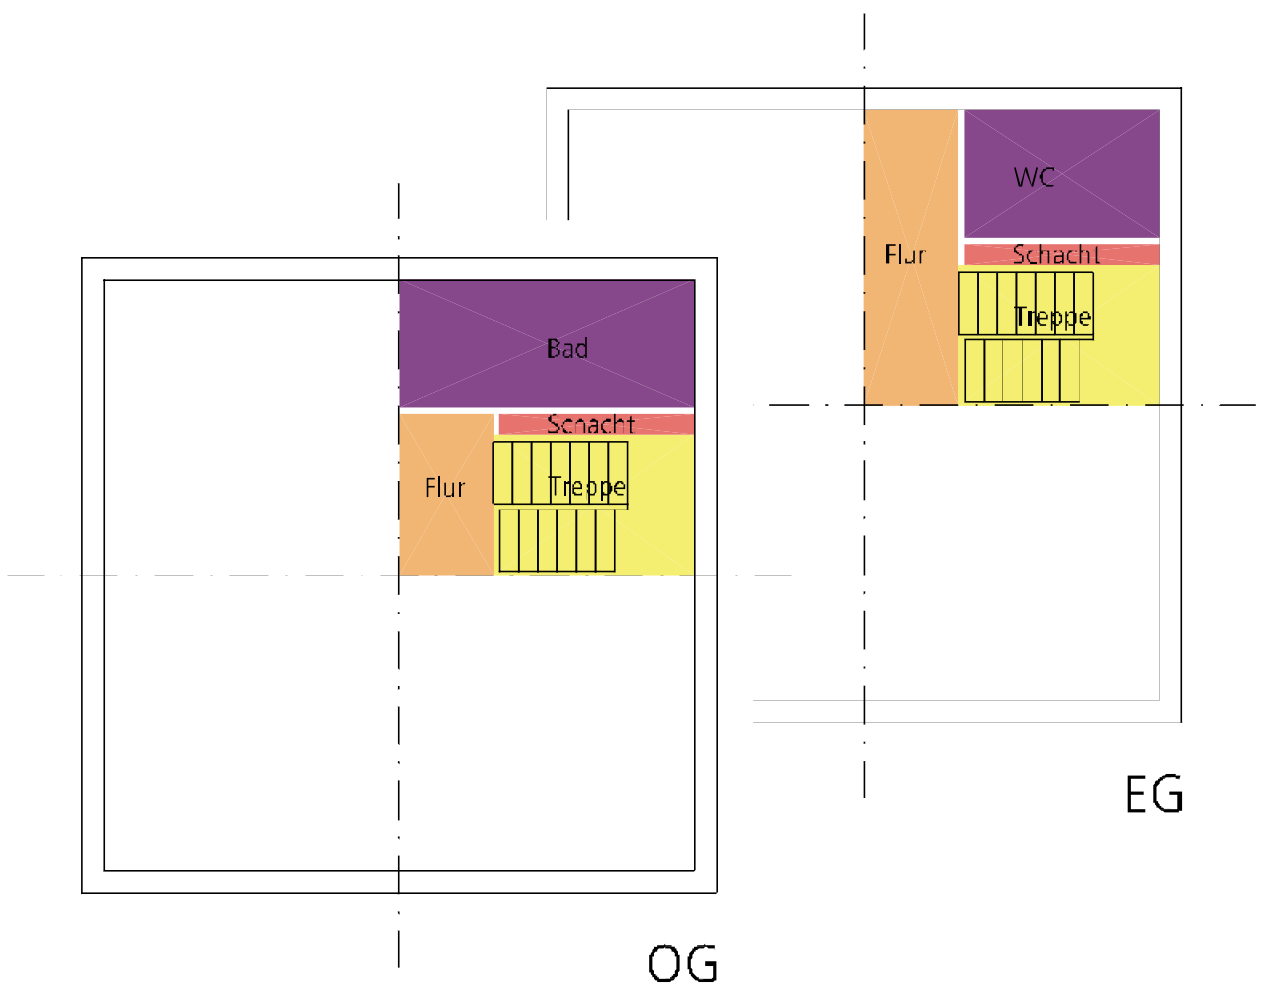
Grundriss, Modul für Raum- und Mediierschliessung
